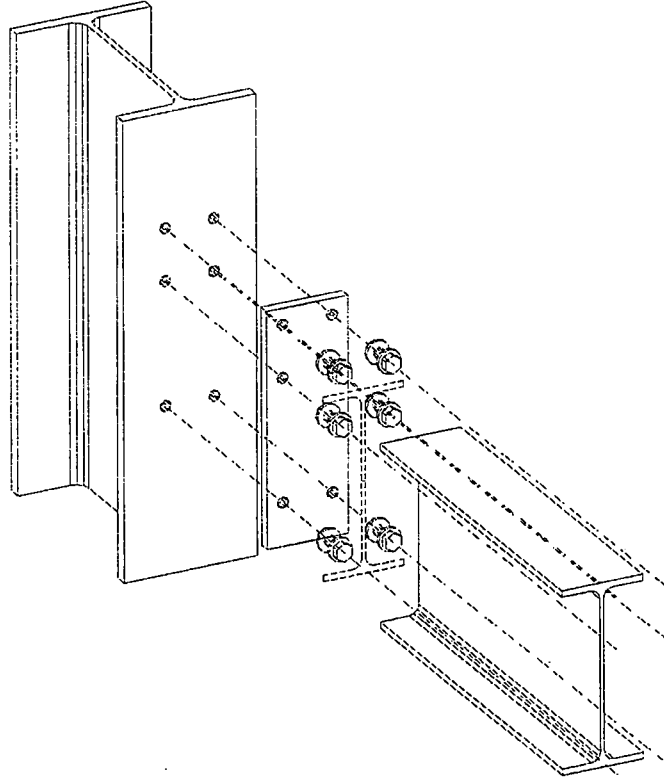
Biegesteifer Stirnplattenstoß, Explosionszeichnung
